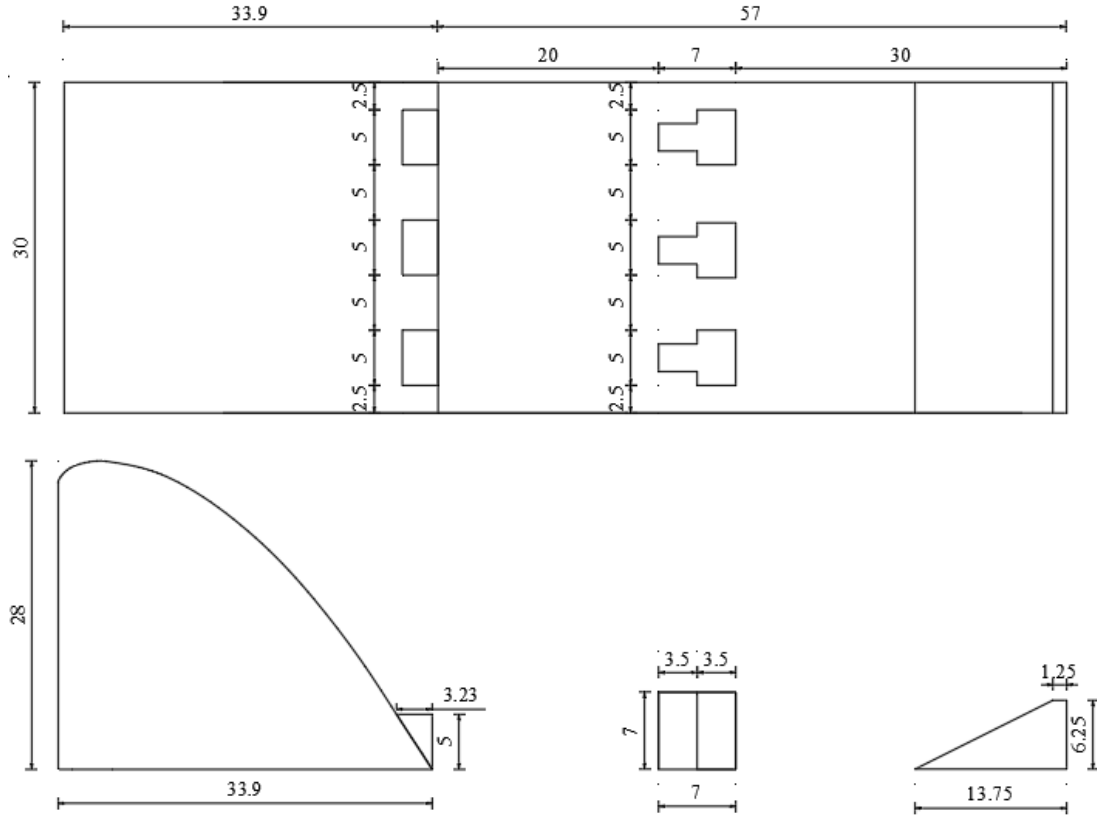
Trapez kesitli tek sıra enerji kırıcı blokların yerleşim planı
